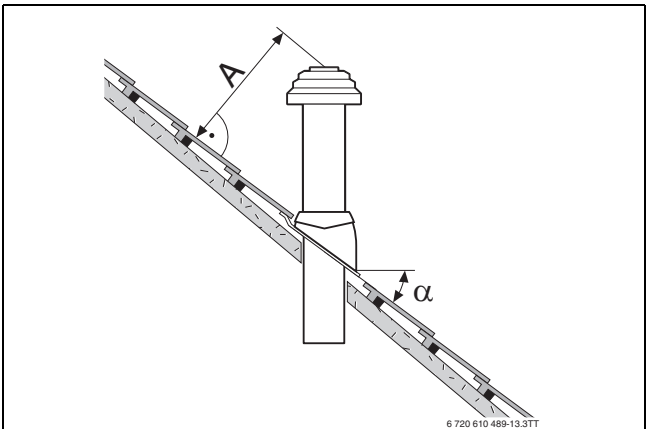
Abstandsmaße und Dachneigungen bei Schrägdach
